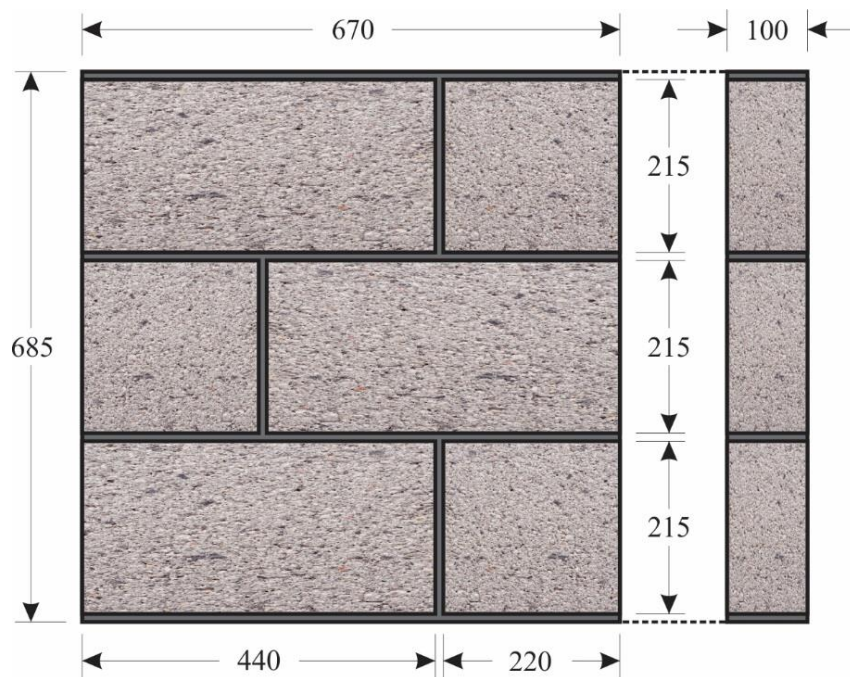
Esquemático de murete de bloques de concreto ligero (mm).
